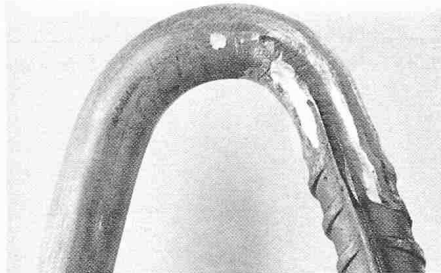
Biegeprobe, geschweisst mit 23/12-Elektrode
